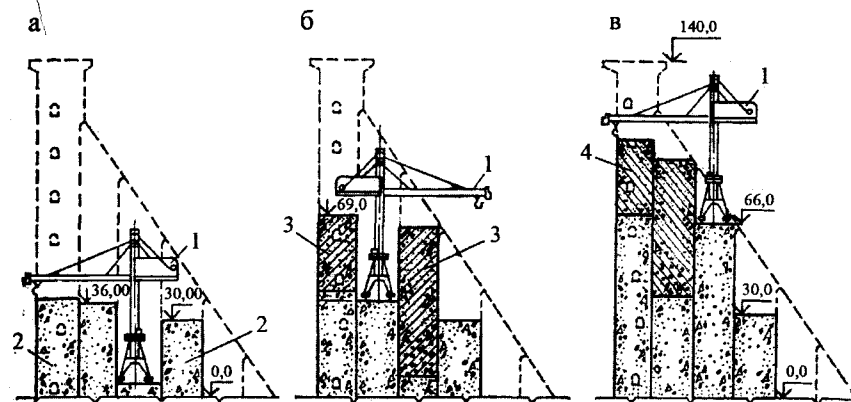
Схема бетонирования плотин самоподъемными кранами без эстакад: а, б, в – этапы бетонирования сооружения, 1 – кран КБГС-1000, 2, 3, 4 – блоки, бетонлируемые соответственно на первом, втором и третьем этапах
